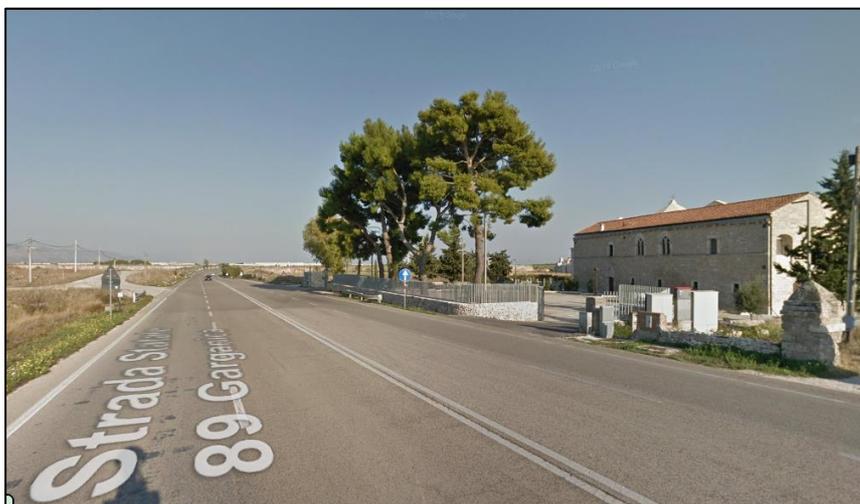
Sezione stradale attuale, in corrispondenza dell'Abbazia San Leonardo
